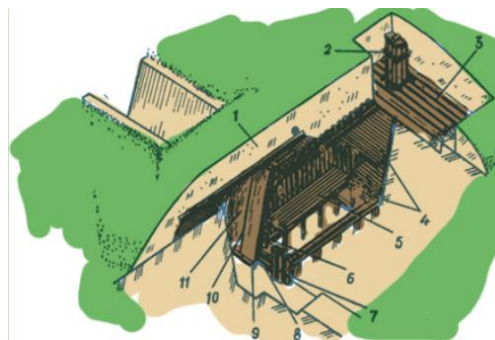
Конструкція бліндажу з дерев'яних колод. [30] 1 – перекрита ділянка траншеї; 2 – вентиляційний короб; 3 – накат; 4 – нари; 5 – місце для сидіння; 6 – піч з місцевих матеріалів; 7 – стояк входу; 8 – дверний щит; 9 – привантажувальний елемент завіси; 10 – тяги з 2-міліметрового відпаленого дроту; 11 – герметизувальна завіса.
